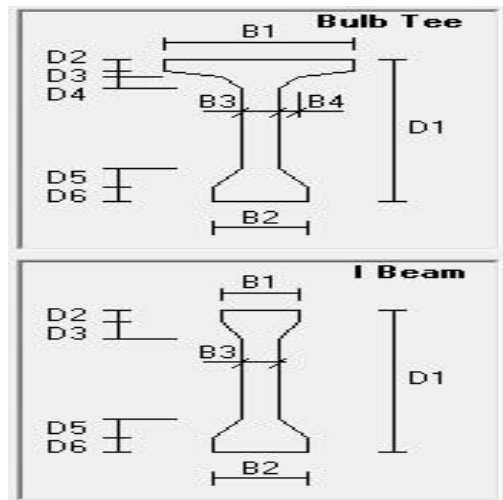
Dimensiones de las secciones de las vigas interiores y exteriores. (SAP2000).
